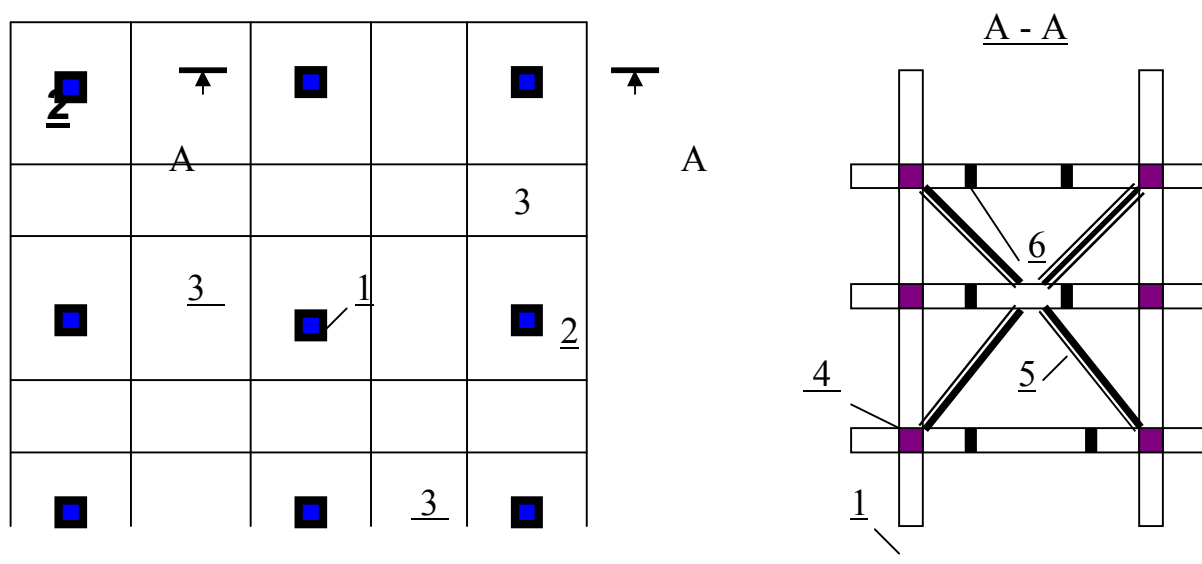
Конструктивная схема системы «КУБ» (каркас): 1 – колонна 3-х этажной разрезки; 2 – надколонные плиты; 3 – рядовые плиты; 4 – стыки колонн и плит перекрытий; 5 – связи; 6 – стыки между плитами.
